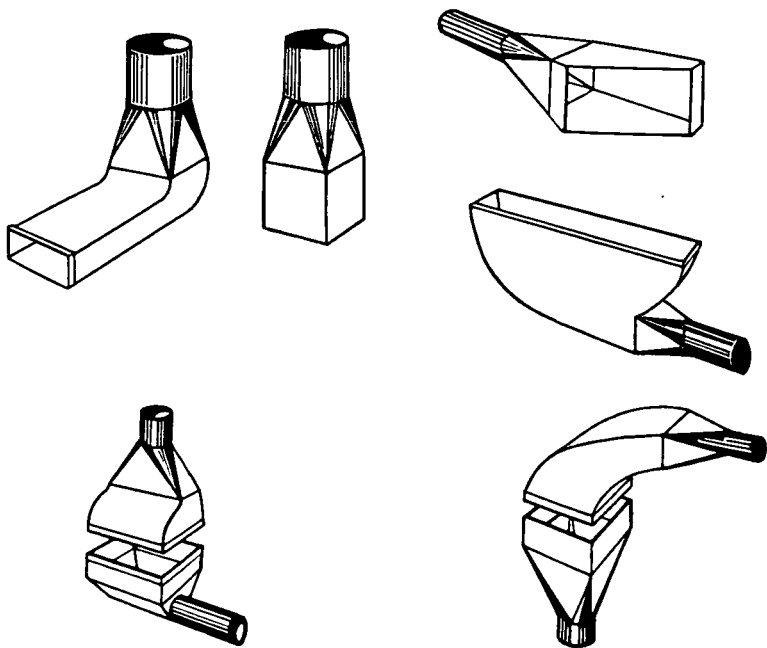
Quelques types de hottes et de capots de forme adaptée à des machines différentes.
